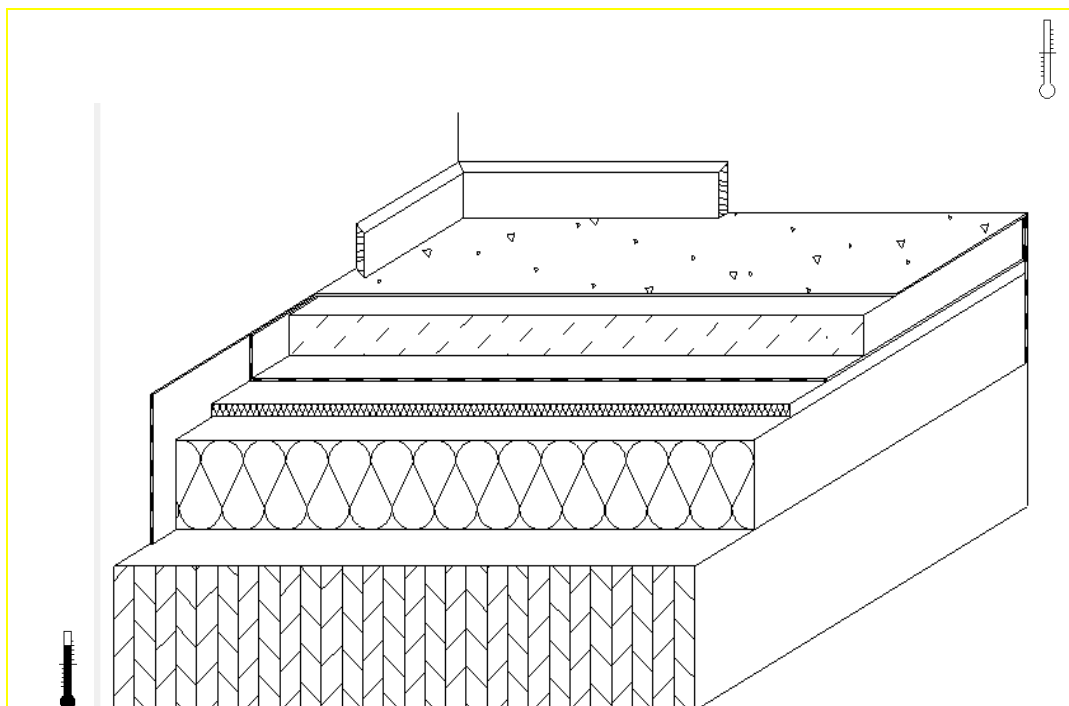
Massivholzdecke gedämmt zu unbeheiztem Dachraum
